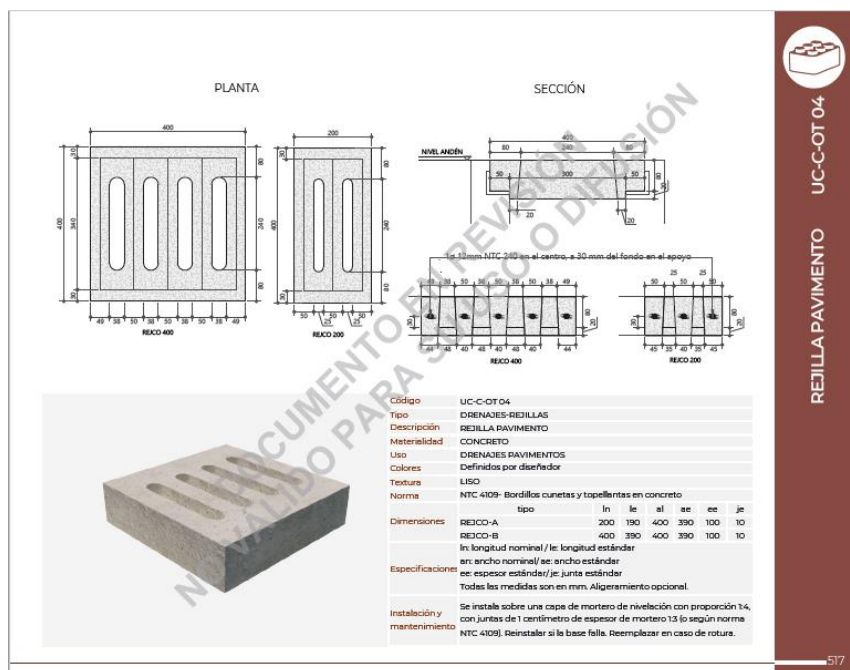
Ficha técnica UC-C-OT 04 Rejilla Pavimento
